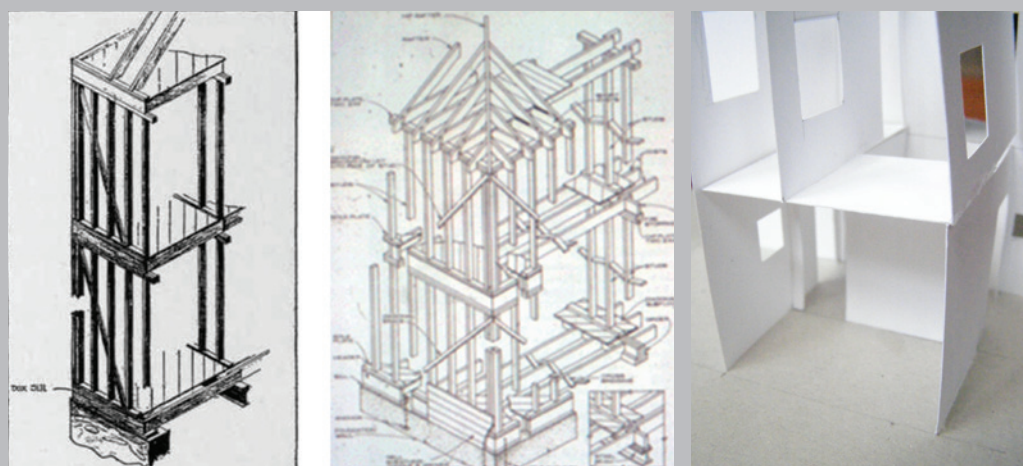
(Izquierda) Proceso de construcción de la estructura de la casa. / Fig.41. (Derecha) Maqueta construida por el autor en la que se aprecian alabeos de los planos verticales.
